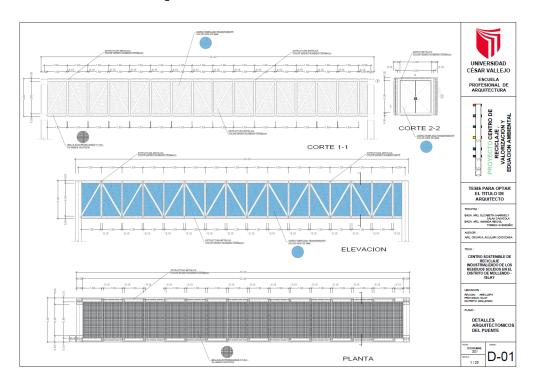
Plano de Detalles Arquitectónicos de Puente FUENTE: Elaboración Propia
